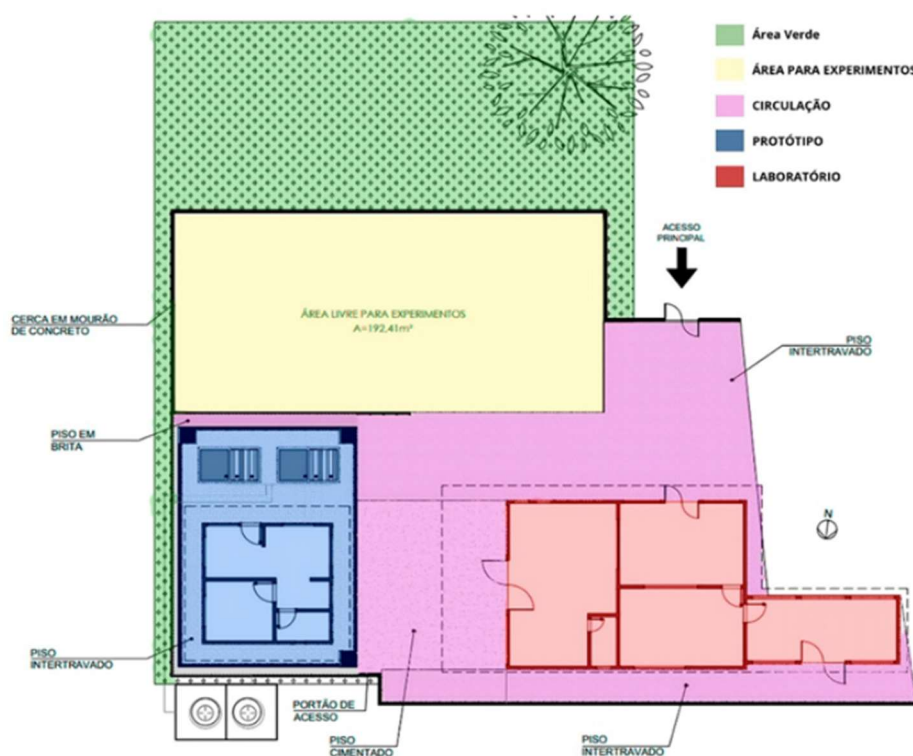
Planta de layout do Laboratório de Tecnologias das Construções (LABTEC).
